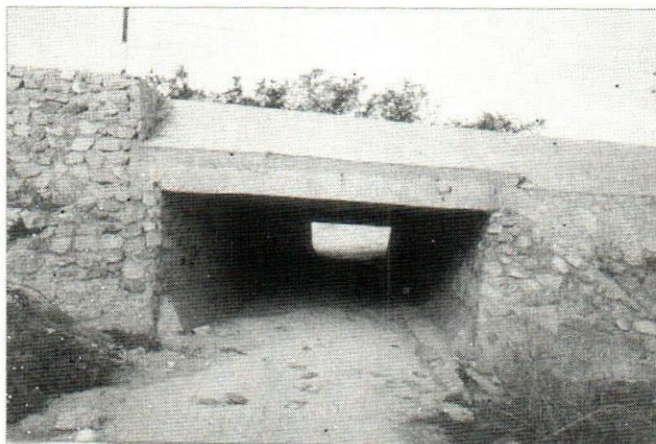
Alcantarilla con losa de concreto armado y estribos de mampostería
